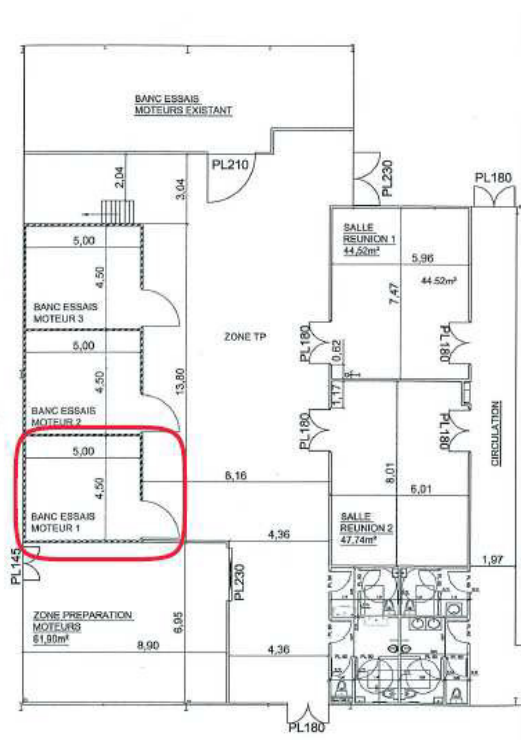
Implantation de la cellule concernée sur le plan de masse du bâtiment
